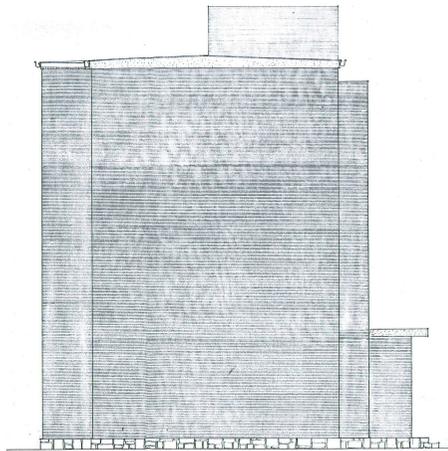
Alzado lateral, con el muro ciego de ladrillo, representativo de todas las tipologías de bloque. Extracto del plano A-2 del proyecto.
